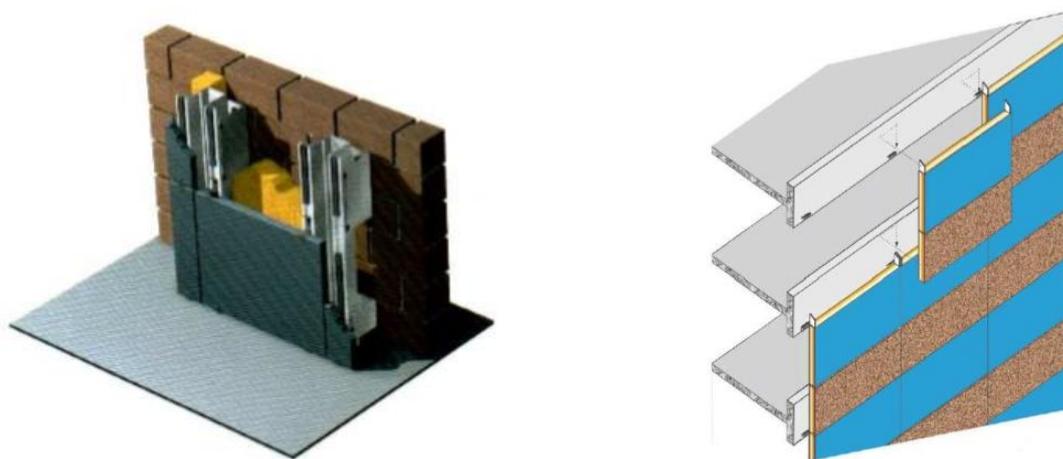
Sistemas de fachadas ventiladas integradas em edificações (Campos, 2011).
